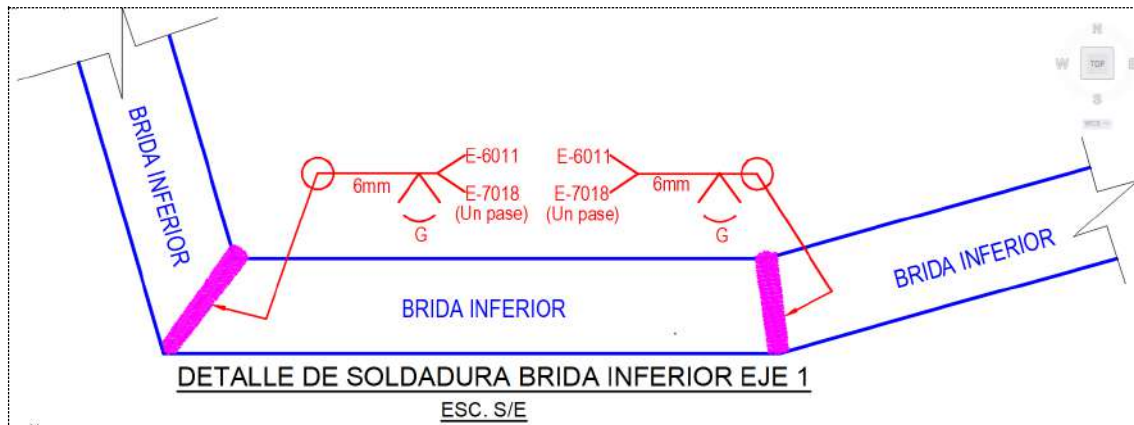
Detalle de armado de brida inferior en el eje 1 de los tijerales
